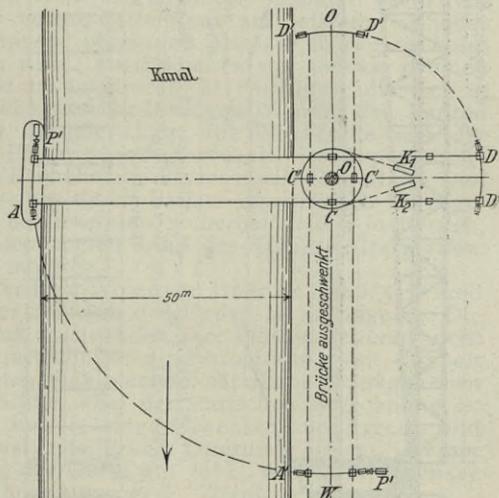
Grundriß-Anordnung der Drehbrücke.
